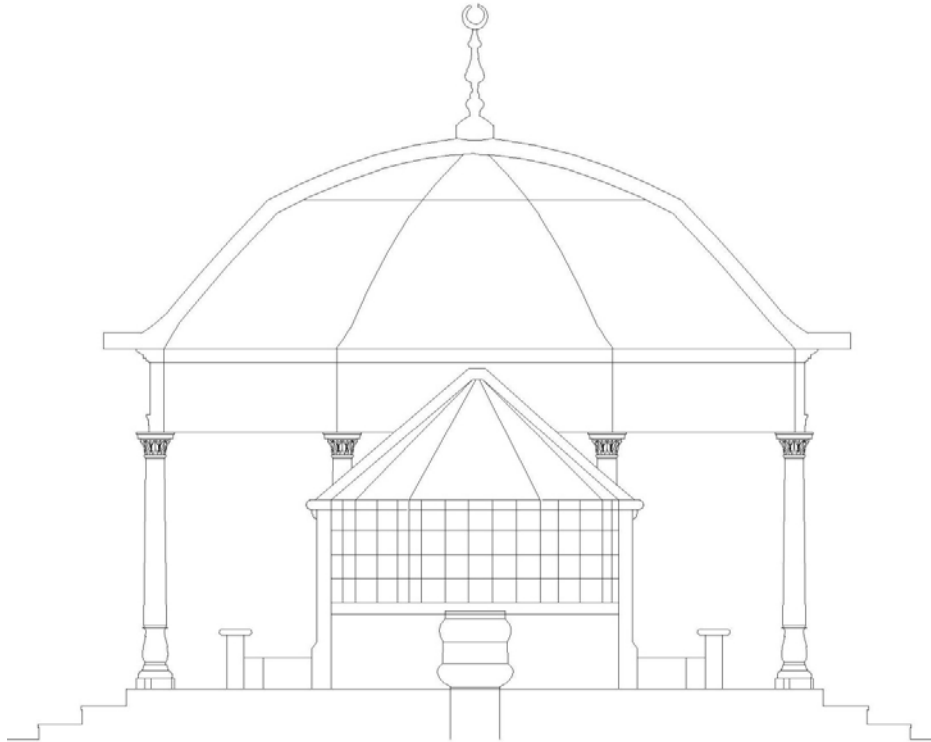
Arap Camii Şadırvan Planı²⁴⁴
